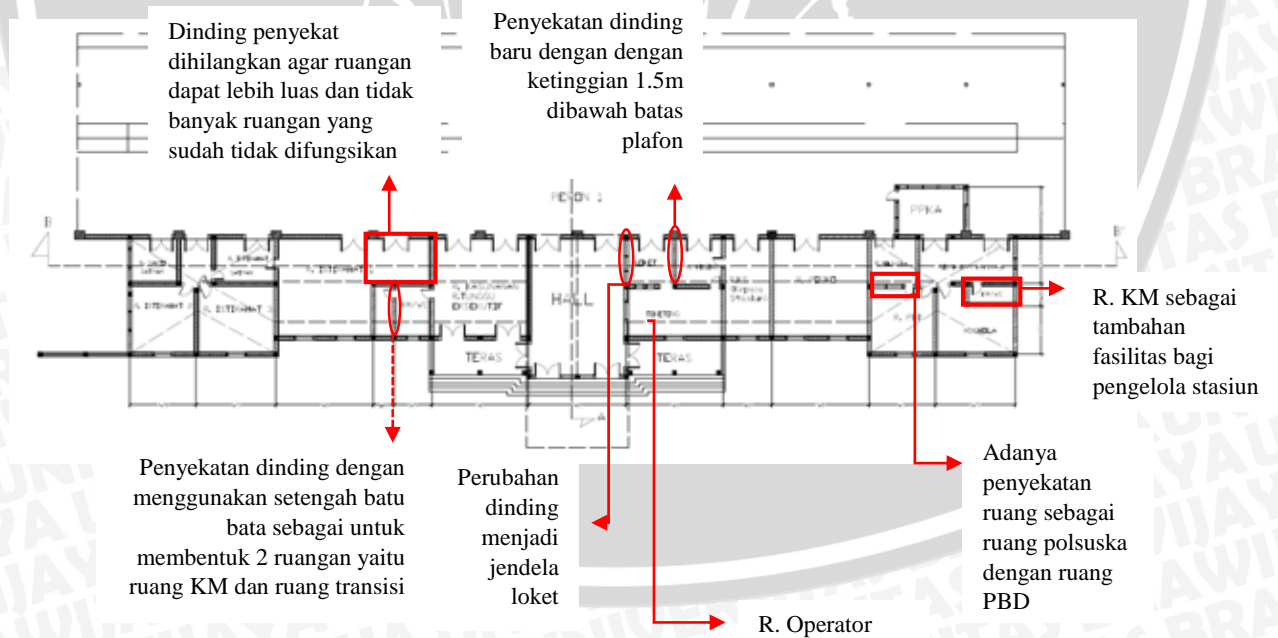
Layout bangunan Stasiun Solo Jebres
